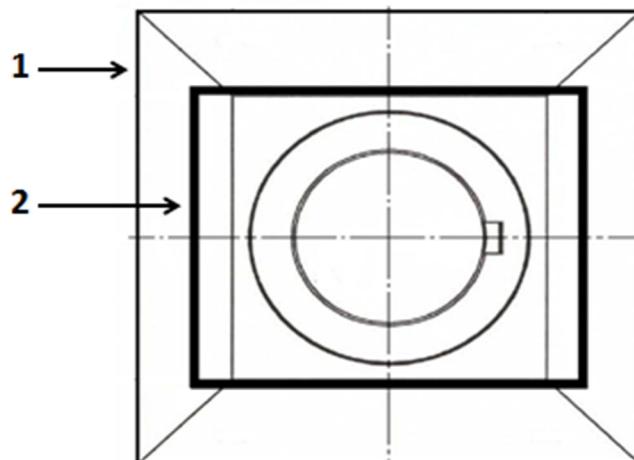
Контур опорной плиты ОП-1к-У, над перекрытиями
